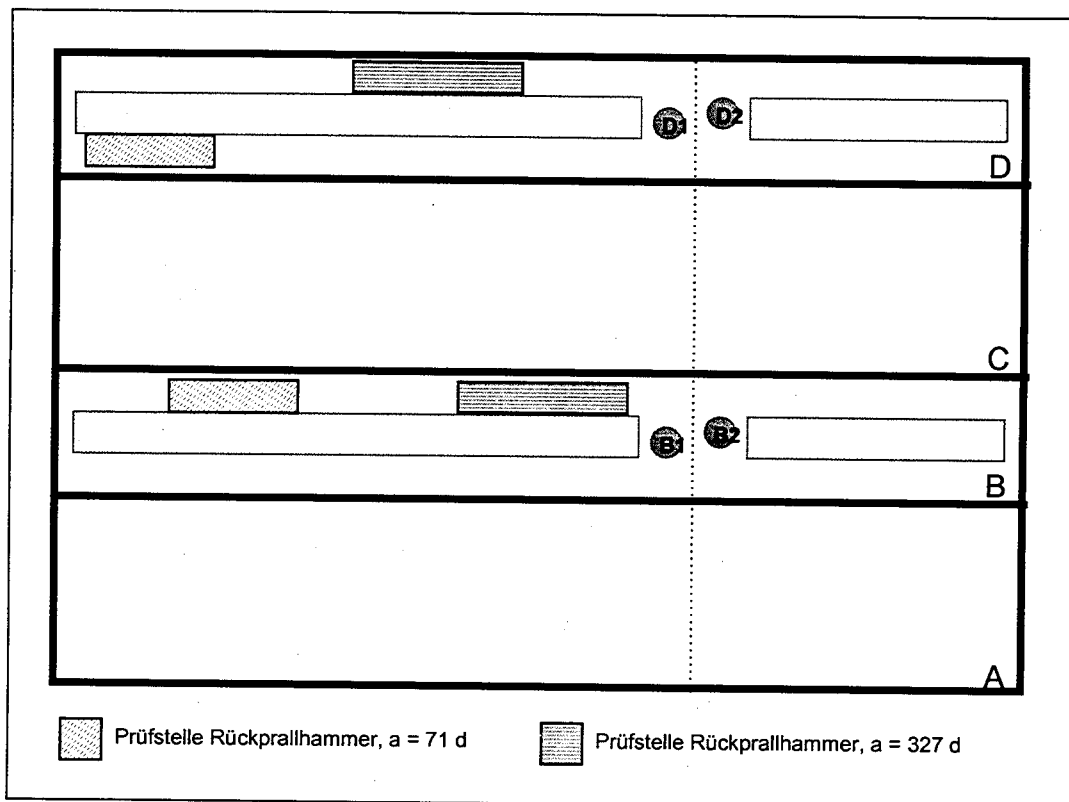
Lage der Prüfflächen am Betonkörper 19
